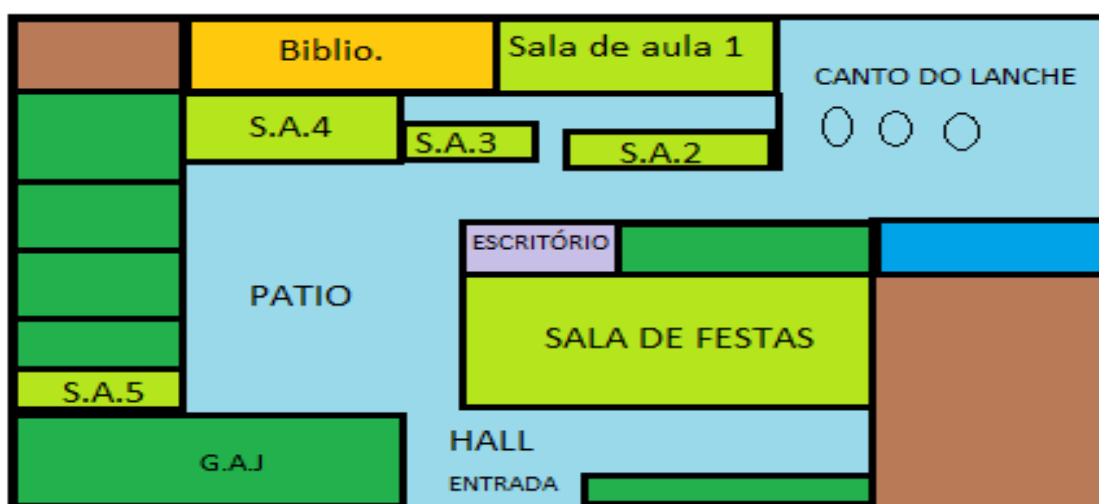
Planta do Espaço Avançar no Bairro da Paz, Salvador da Bahia – Brasil
